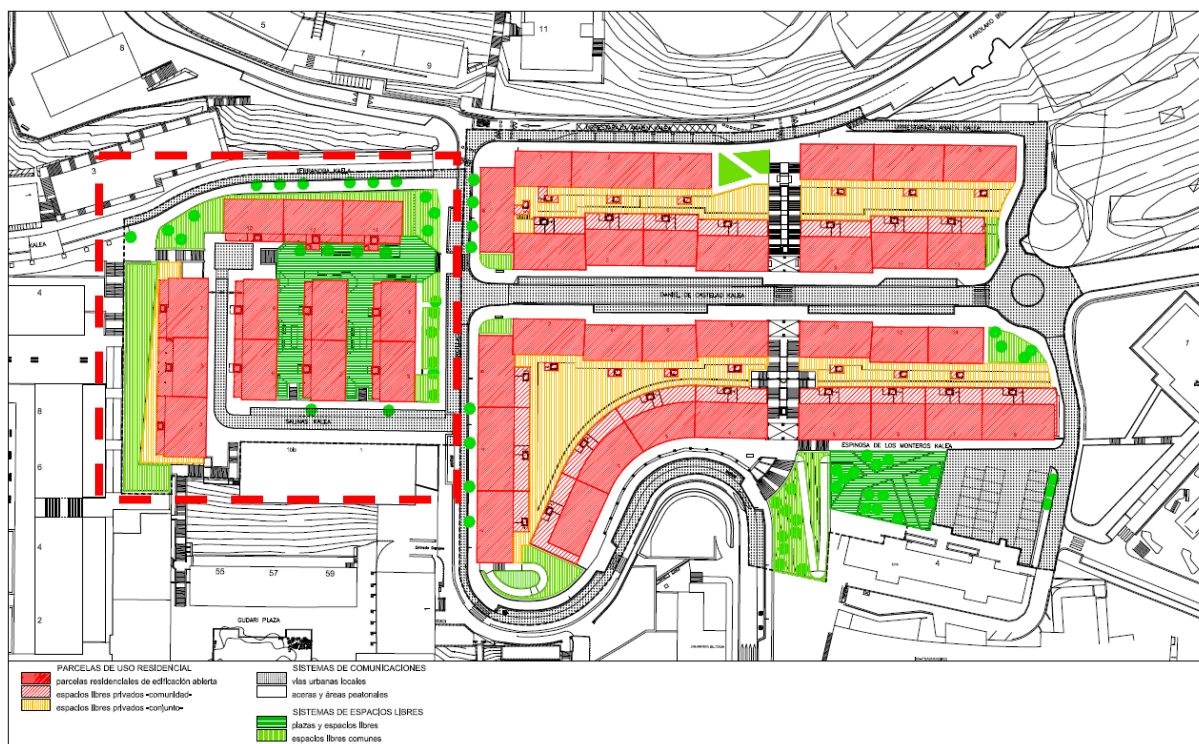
Ordenación pormenorizada de Salinas (izda). Fuente: Plano PRO.11-2 del Plan Especial
